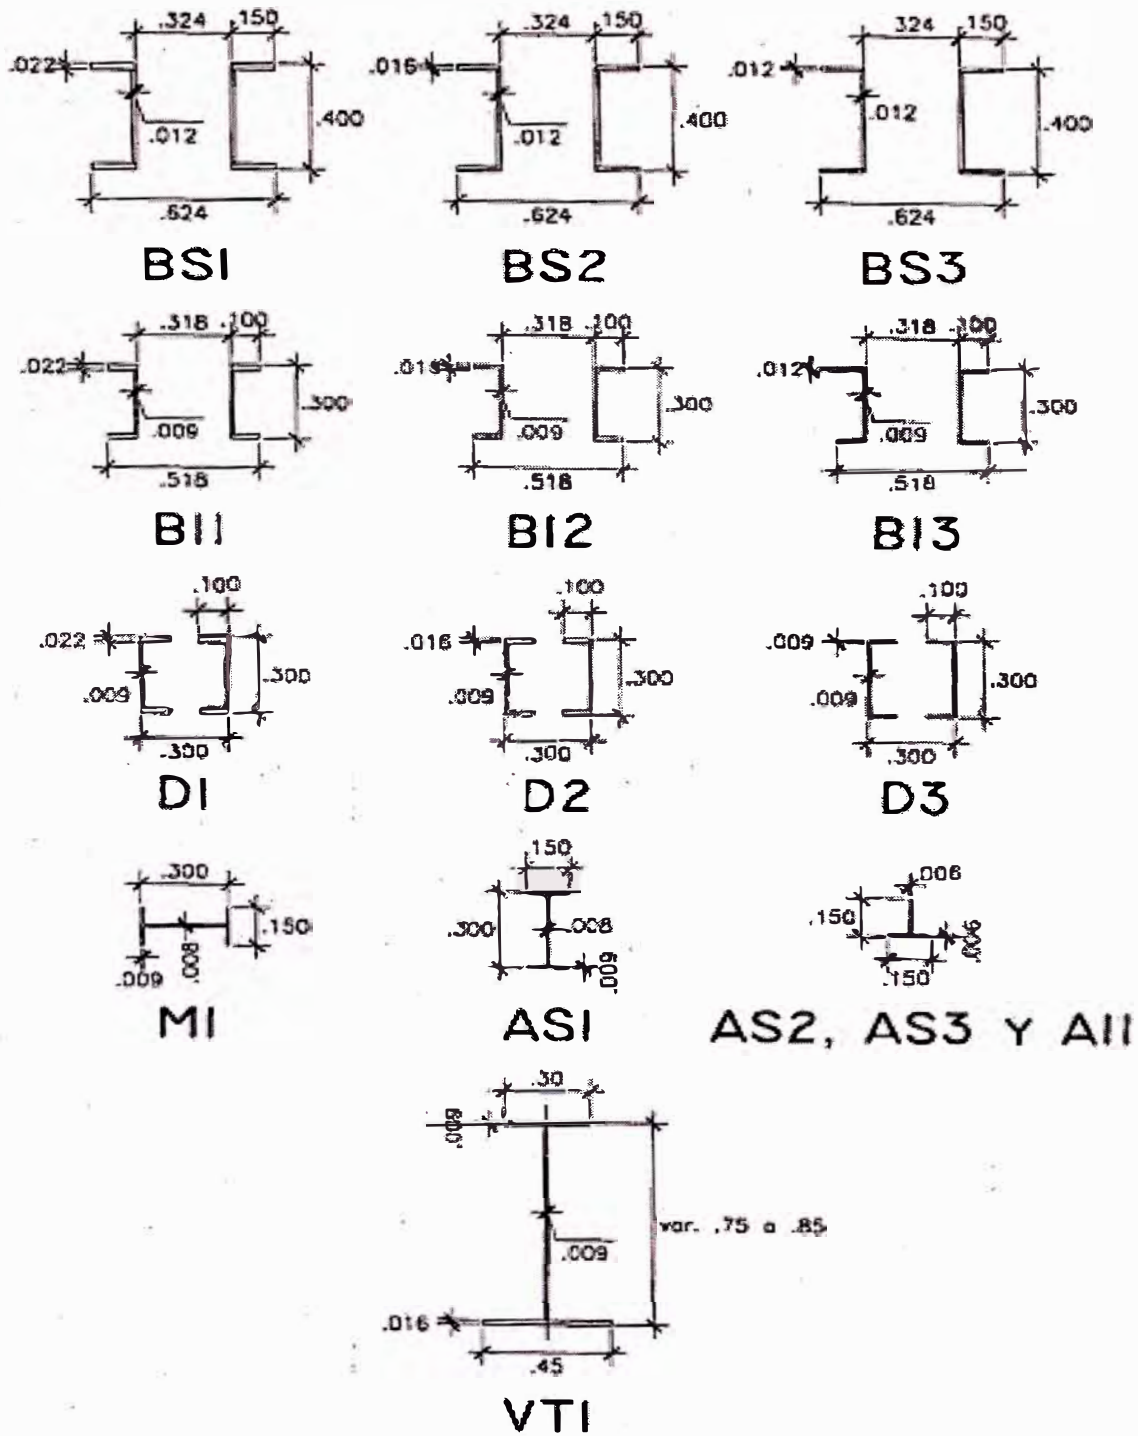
Secciones de la estructura de Acero del Puente Reticulado
